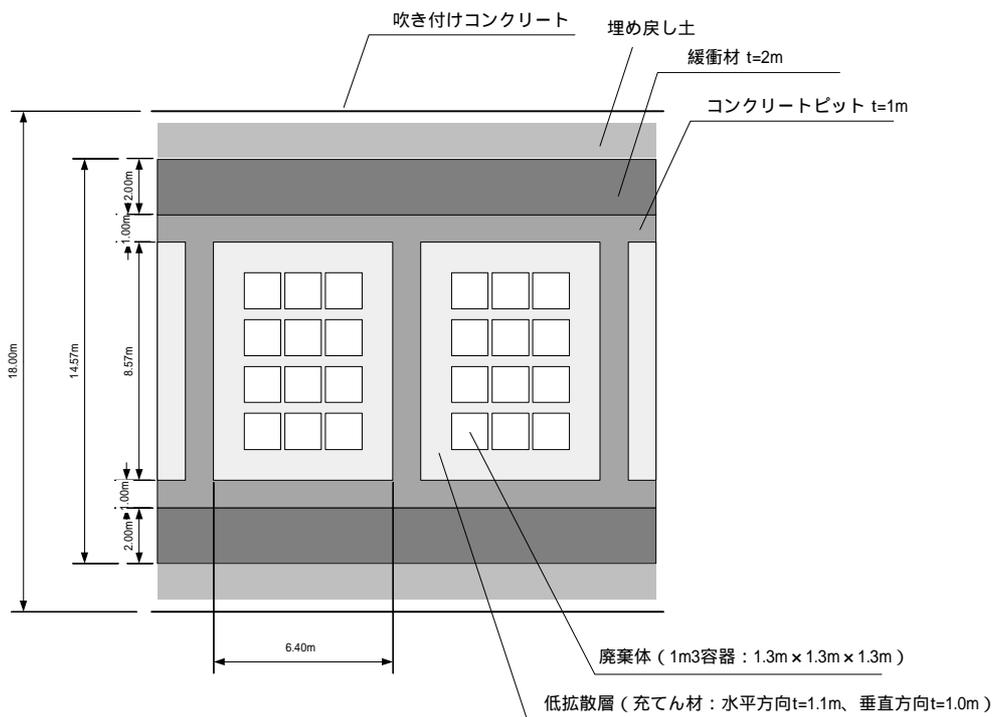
処分施設の水平断面図（トンネル型埋設施設）
